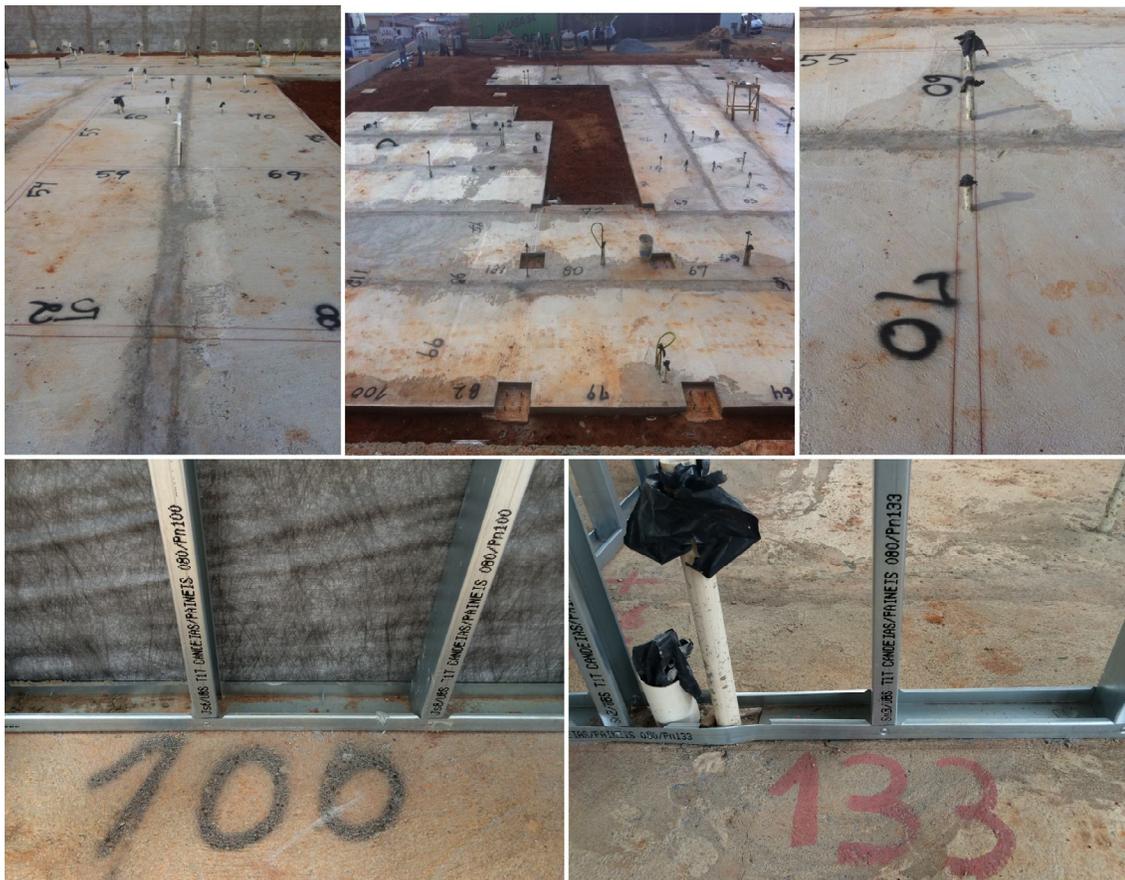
Painéis estruturais da obra, mas especificamente o de número 75.
